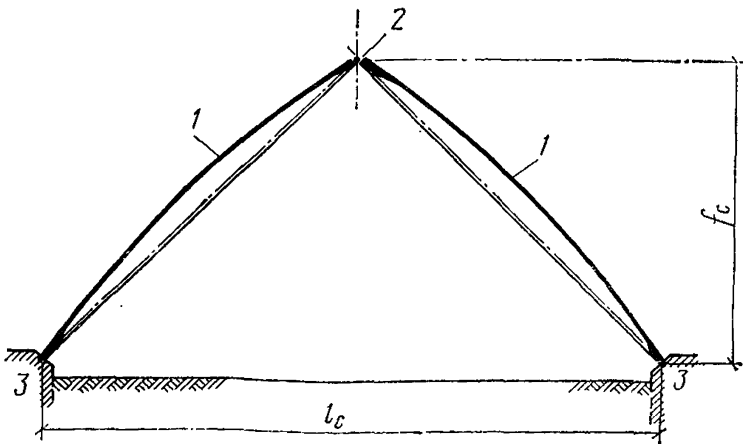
Конструктивная схема сегментного свода, опирающегося на фундаментах
